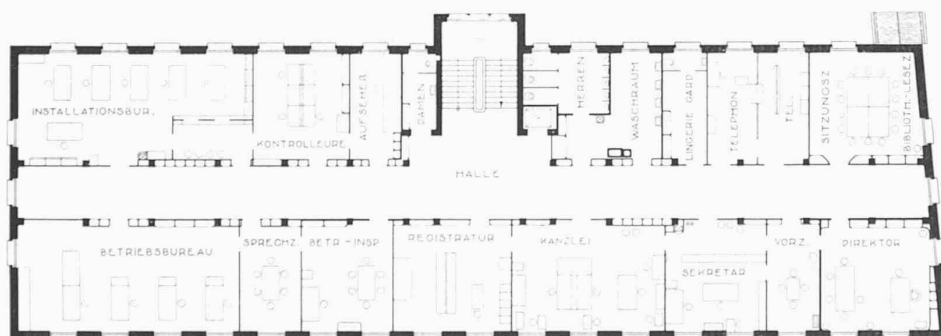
Grundriss vom II. Stock. — Masstab 1:400.
